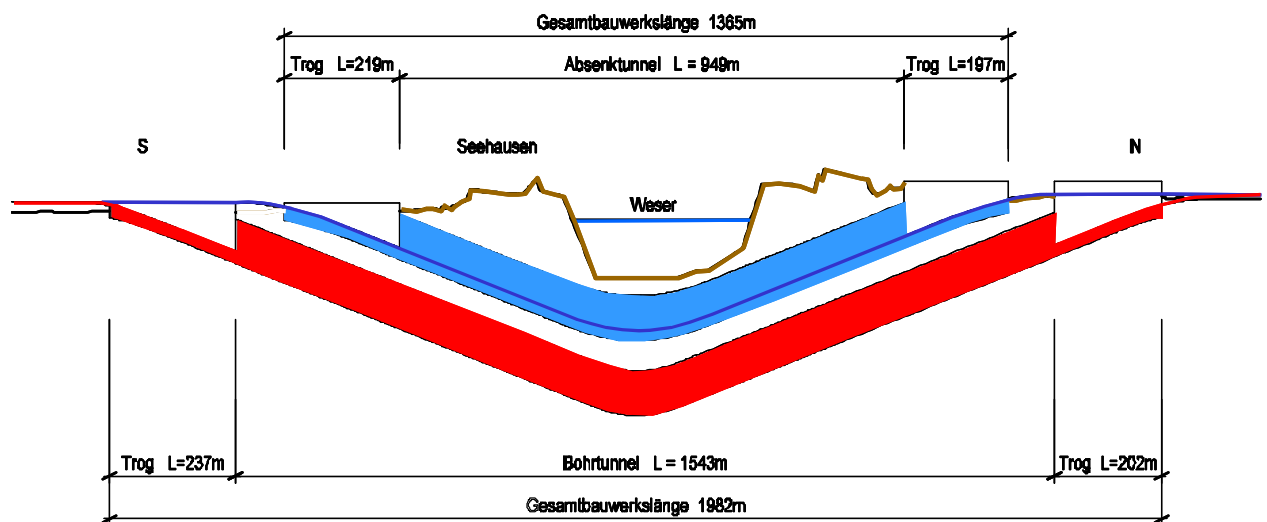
Längsschnitte Bohrtunnel (rot) /Absenktunnel (blau)
